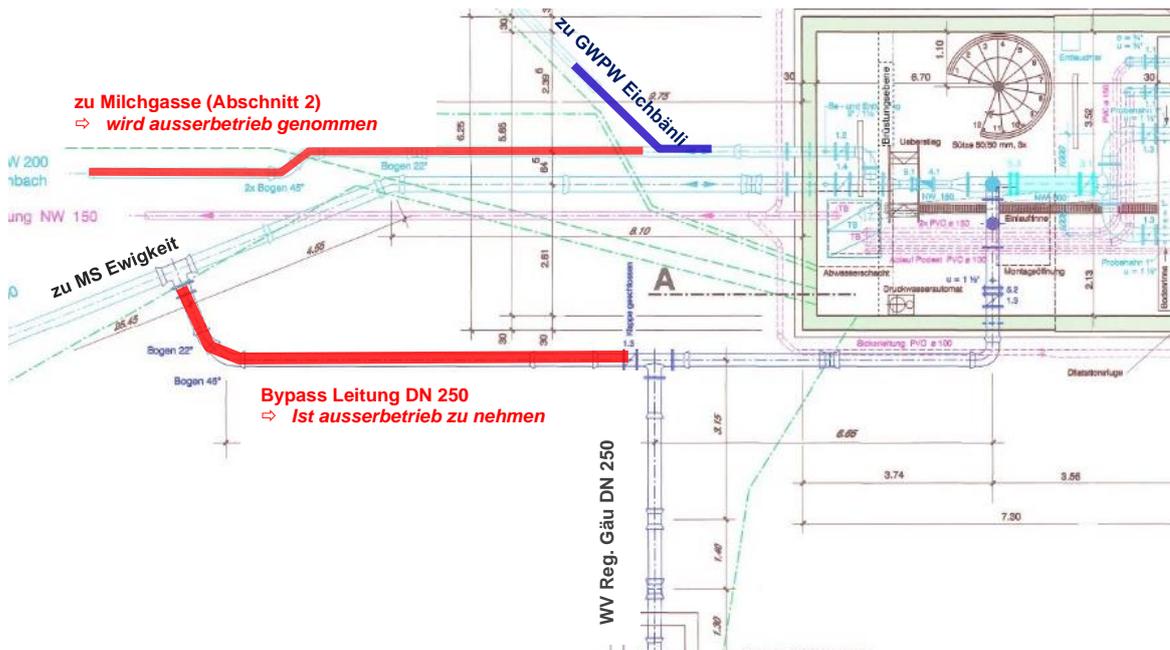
Ausschnitt PdaB Reservoir schlosshubel, 28.10.2013, Grundriss Rohrkeller
